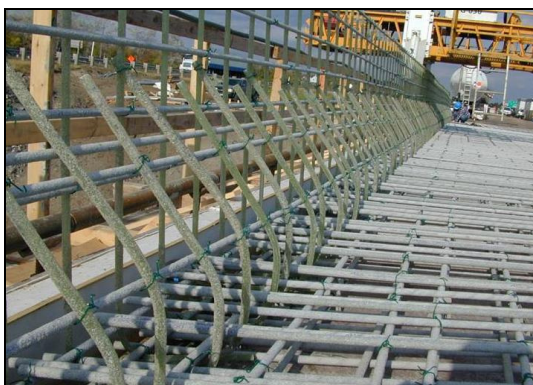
Detalles de tablero de puente con armado de fibra de vidrio.
